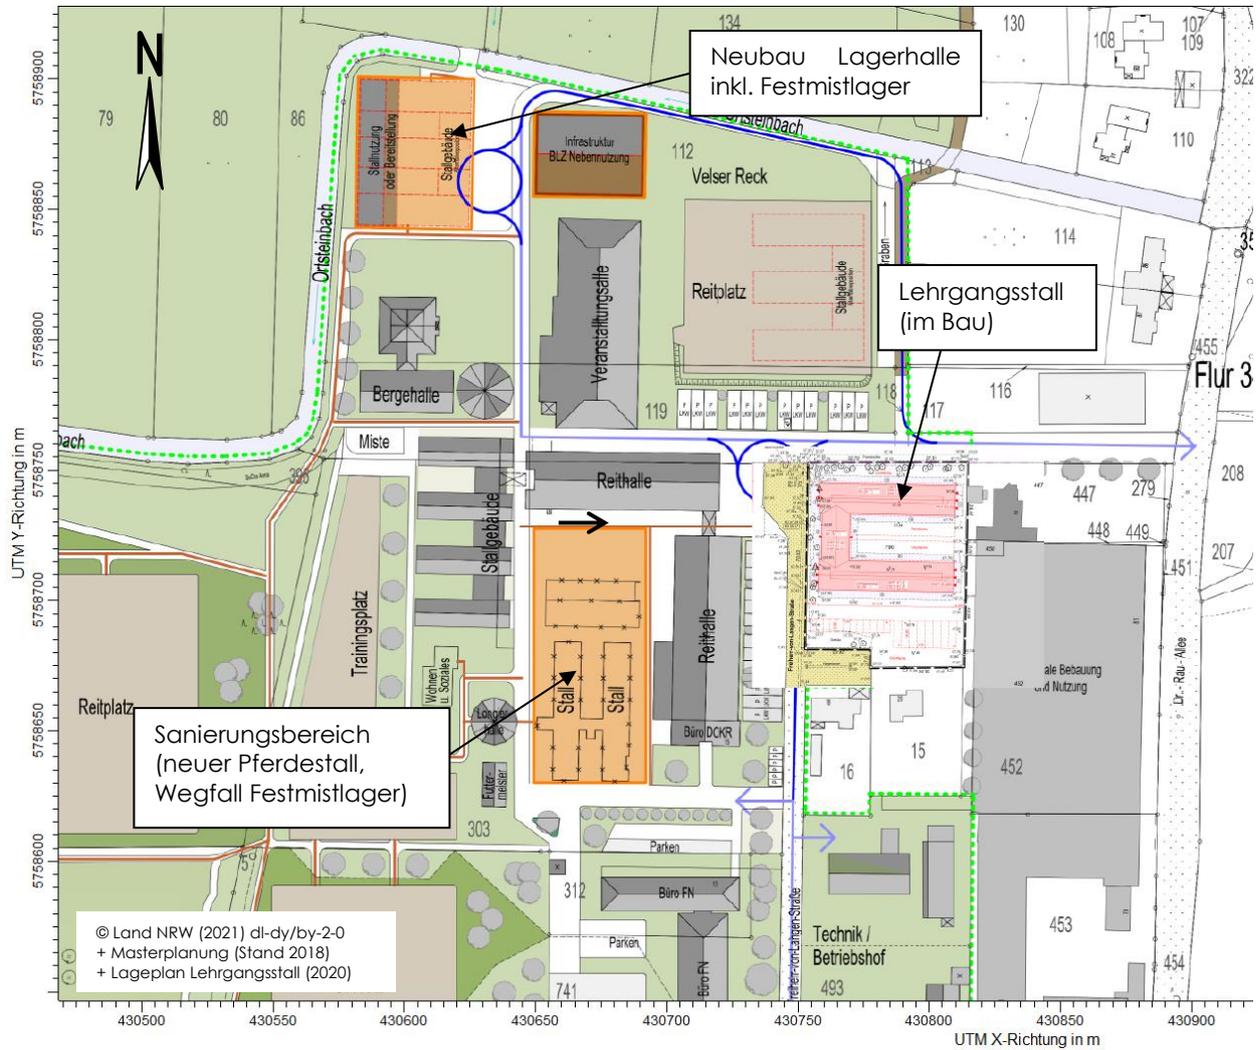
Lageplan DOKR Gesamt-Anlage (Masterplan 2018)
